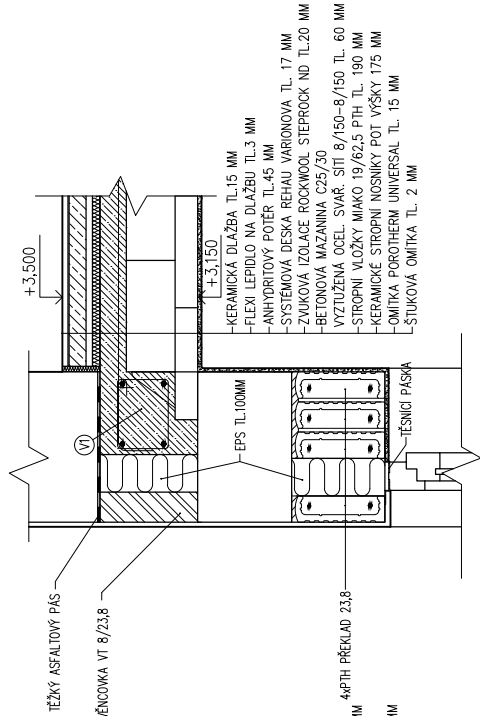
DETAIL NAPOJENÍ FILIGRÁNOVÉHO STROPU
